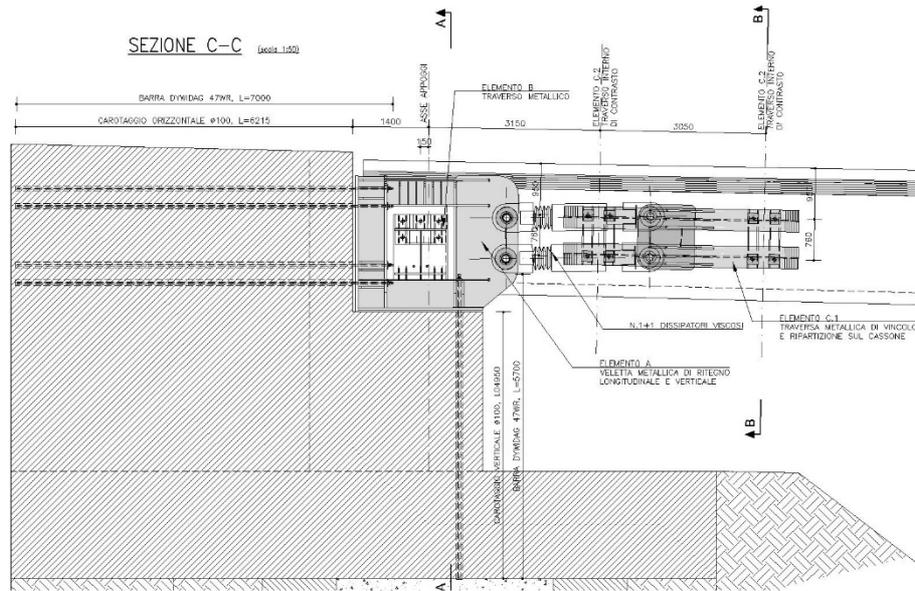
Spalla Sp.1 - Sezione longitudinale
